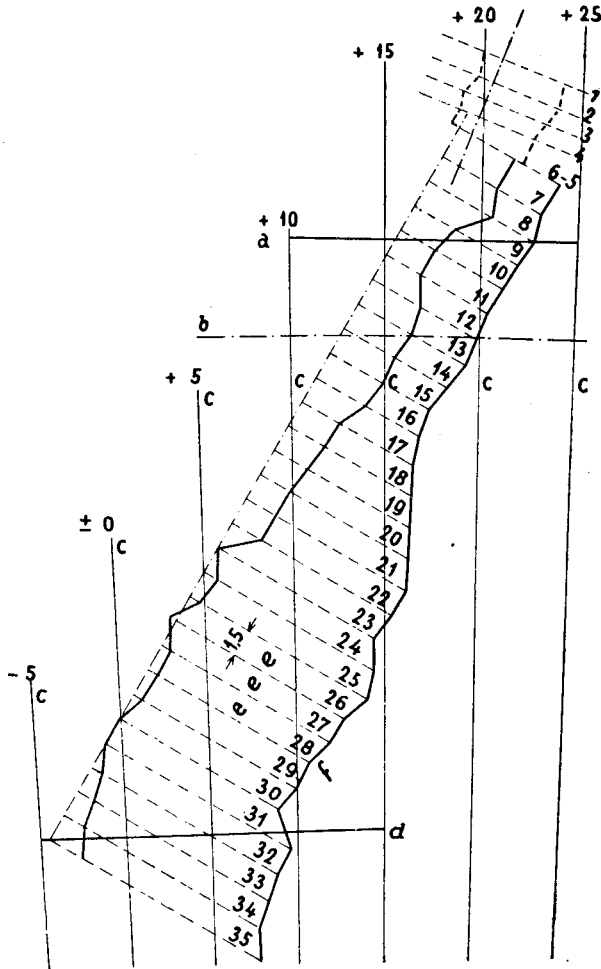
Barrage de Pastviny. Plan de la zone de dislocation. (a) Parement amont du barrage. (b) Axe du barrage. (c) Sections transversales du mur du barrage. (d) Parement aval du barrage. (e) Sections transversales de la dislocation. (f) Section de la dislocation à la cote 436,00.
